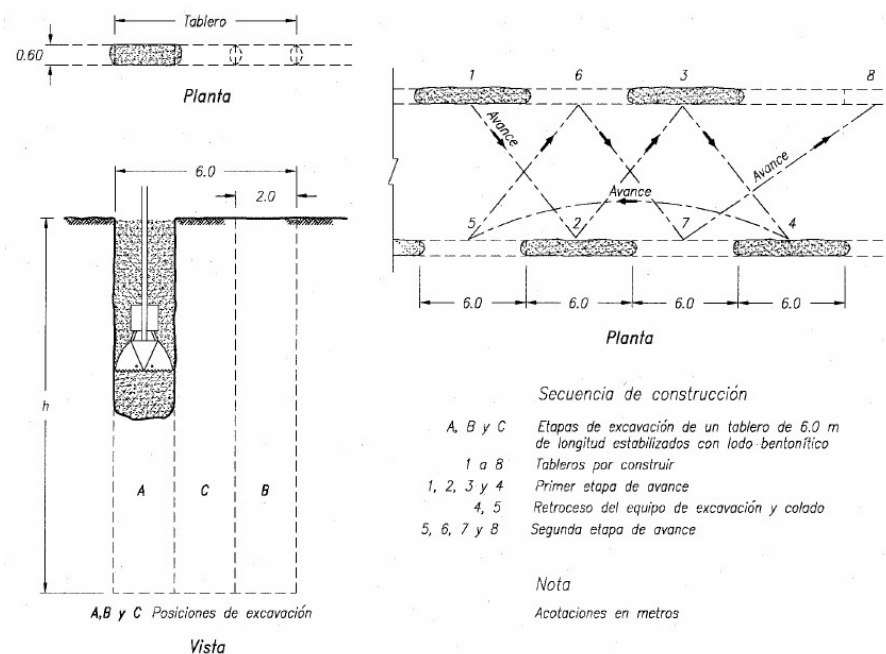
MURO MILÁN CONVENCIONAL CON EXCAVACIÓN EN 3 POSICIONES POR MÓDULO
